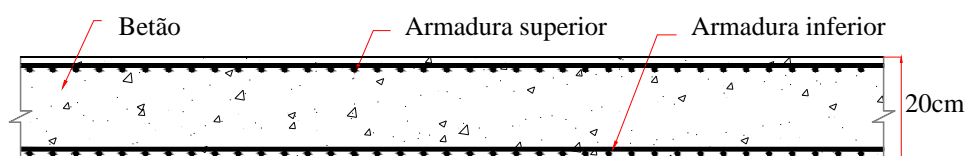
Pavimento de estrutura contínua em laje maciça de betão armado sem isolante (Pav4)
